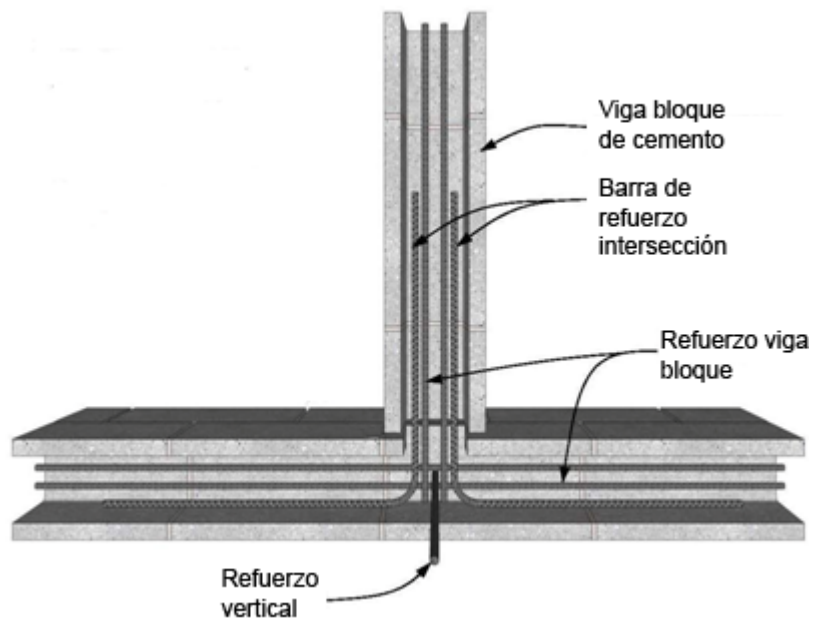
Anclaje de los extremos de las barras de refuerzo horizontal en L (IMI, 2009)
